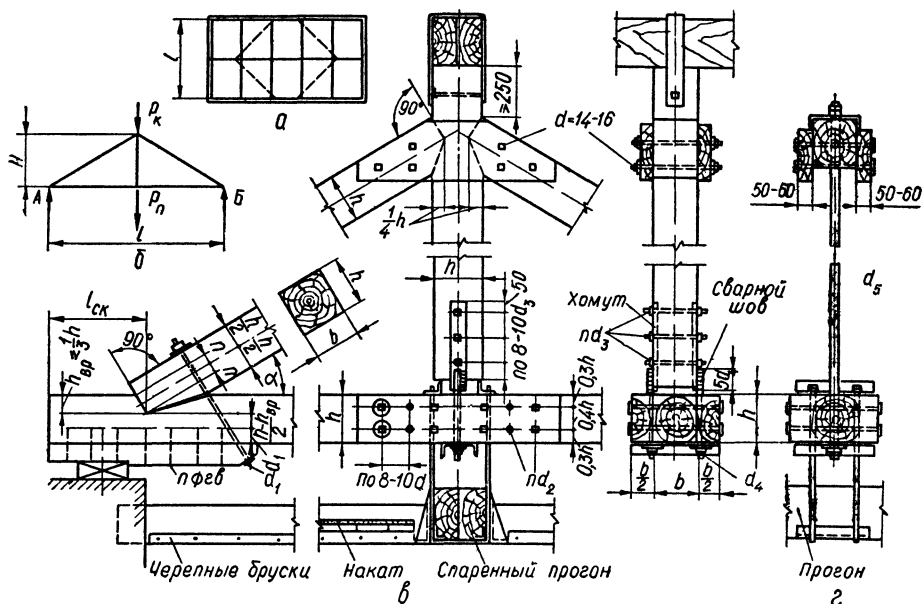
Конструкция треугольной фермы из брусков с одной подвеской:
